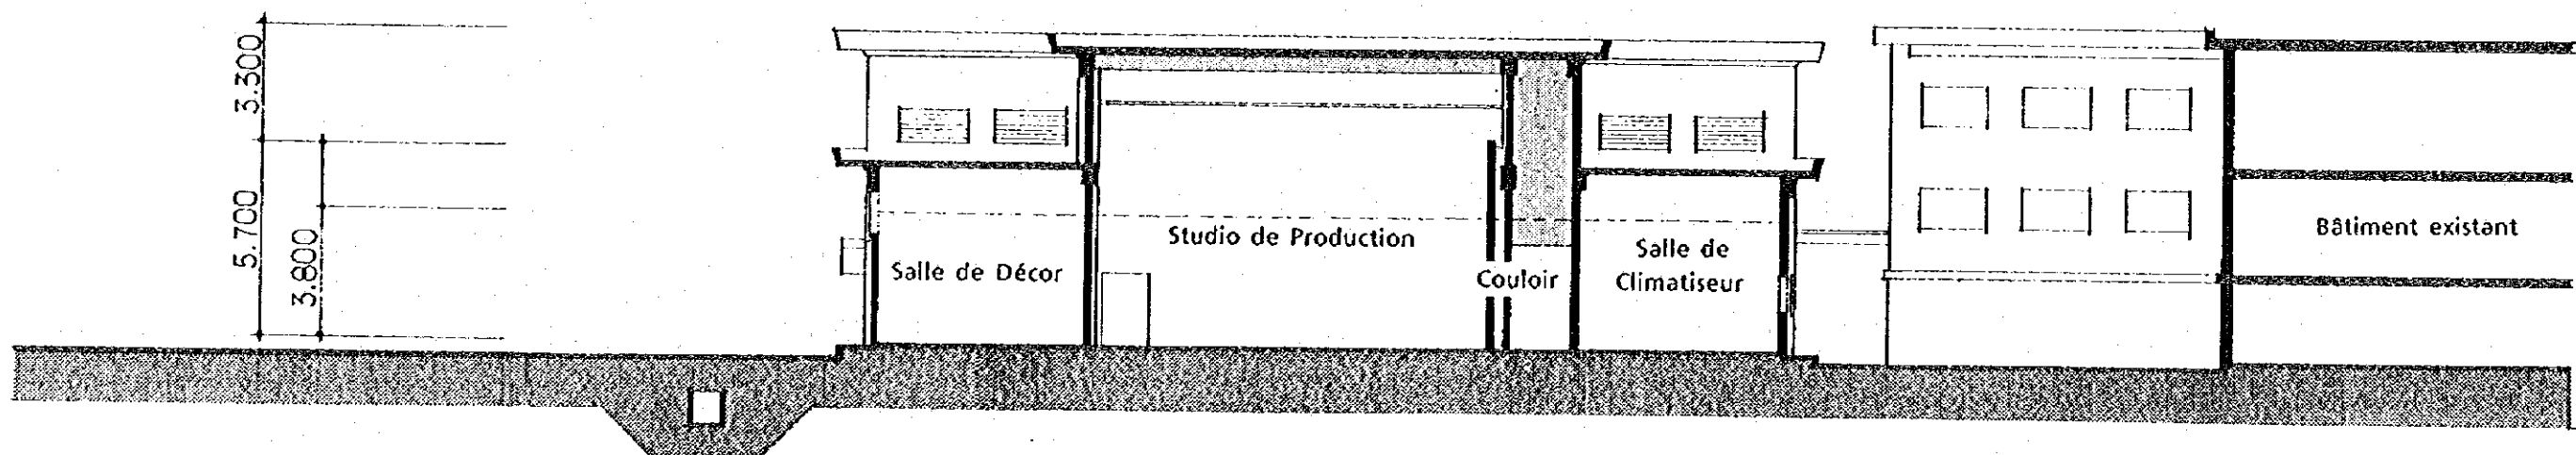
PLAN DU CENTRE DE LA TELEVISION (PROFIL-2)
